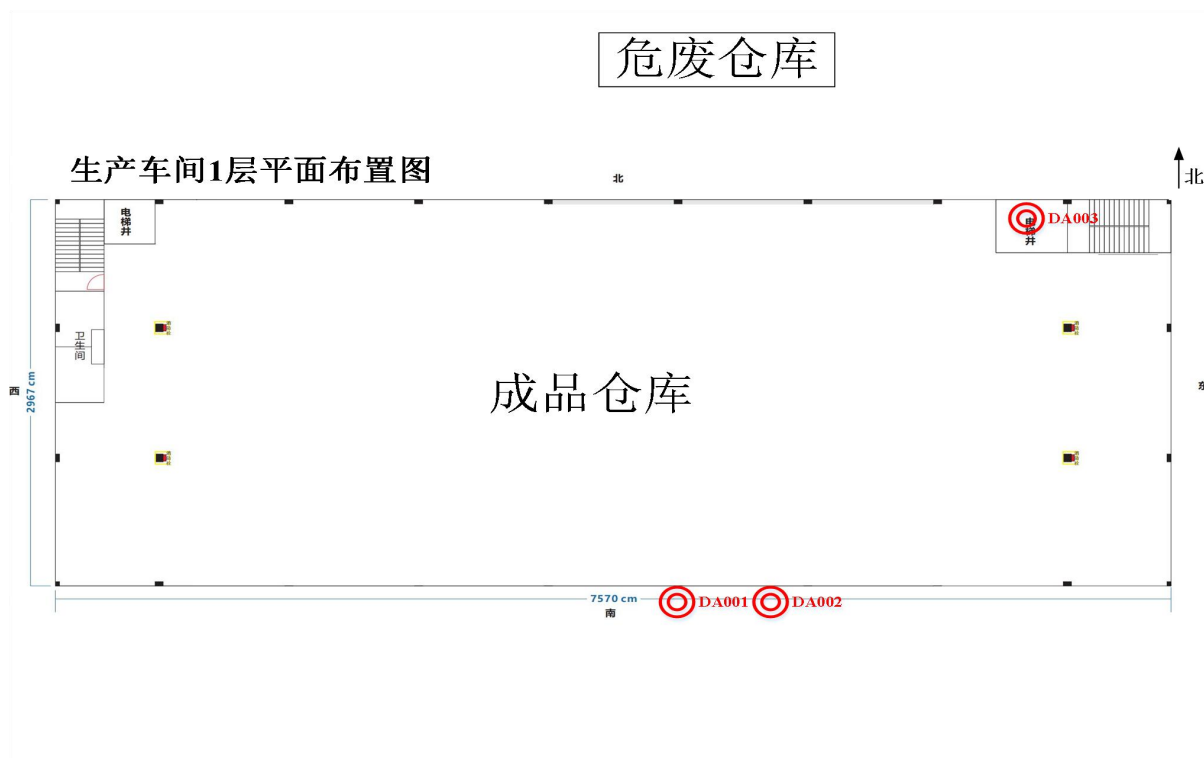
建设项目环评审批生产车间 1 层平面布置图
